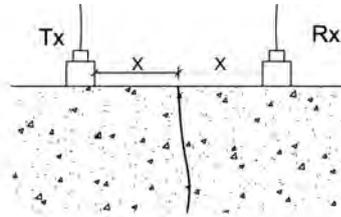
lectura de la profundidad de fisuras/grietas en el hormigón.
